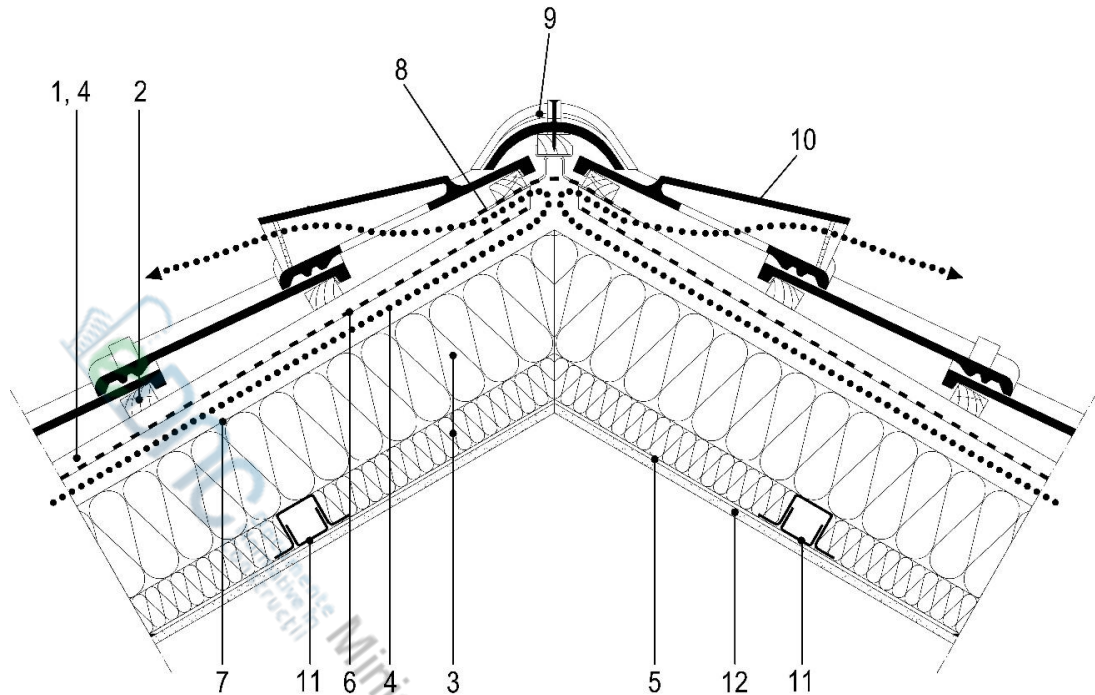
Деталь вентиляции у конька с вентиляционным элементом
